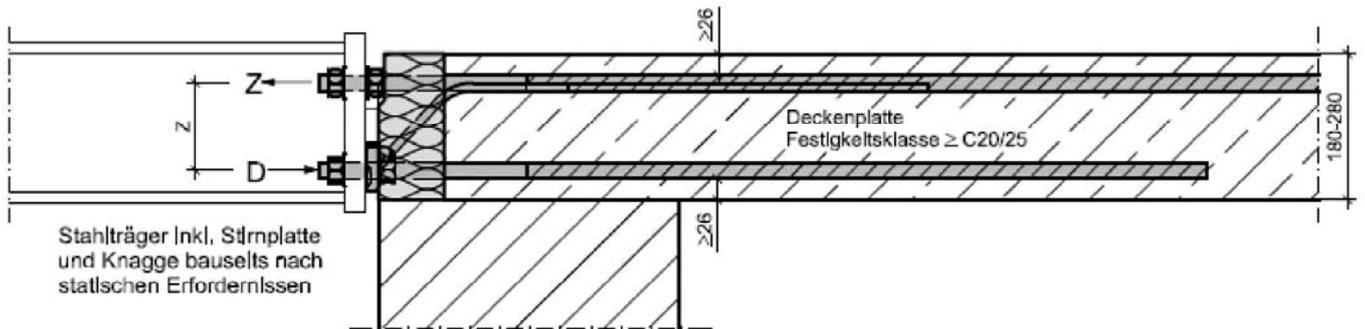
Schöck Isokorb® T Typ SK-MM2-VV1 und T Typ SK-MM2-VV2
